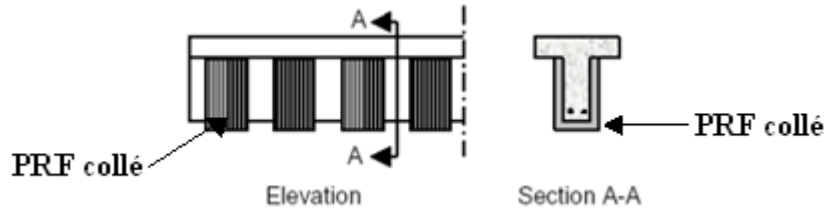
Renforcement au cisaillement d'une poutre par matériaux composites (Isis CANADA, 2006).
